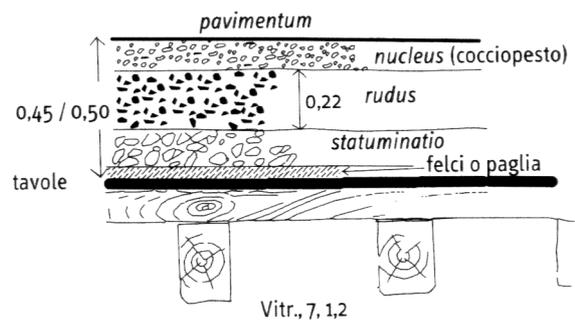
Stratigrafia del pavimento di una terrazza secondo le disposizioni di Vitruvio (GIULIANI 2006)
